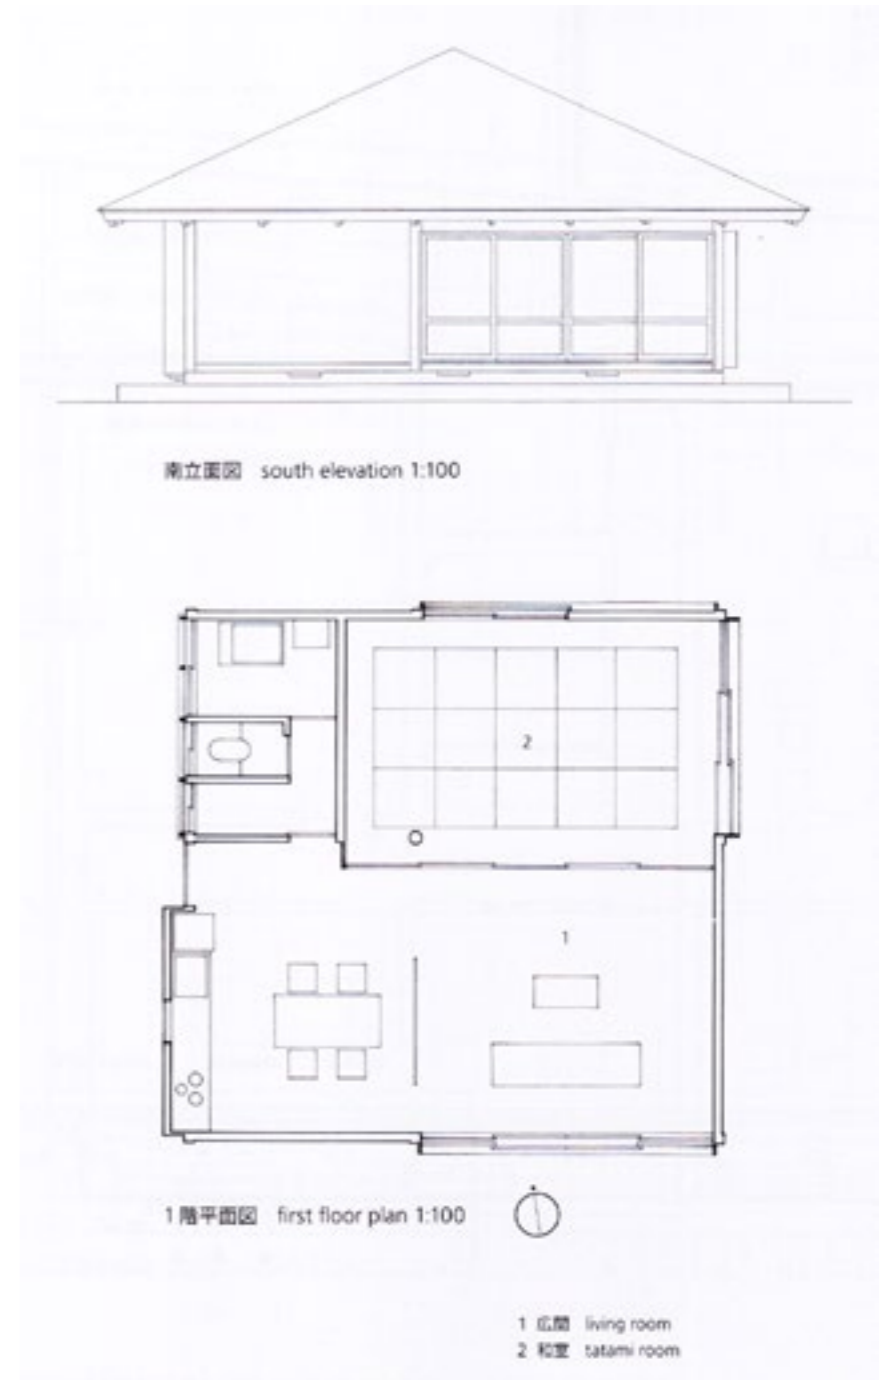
Umbrella House, planos originales. Kazuo Shinohara, 1961
